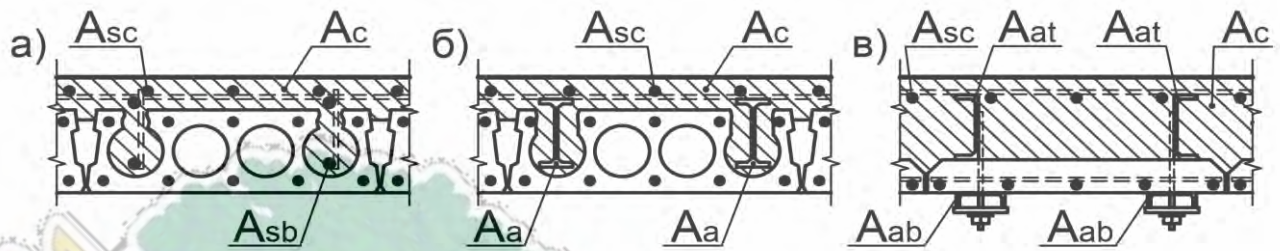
Варіанти підсилення перекриттів приміщень сховищ із збірних залізобетонних плитних конструкцій шляхом збільшення їх перерізів за допомогою: а) арматурних каркасів і сіток; б), в) сталевих профілів і арматурних сіток
